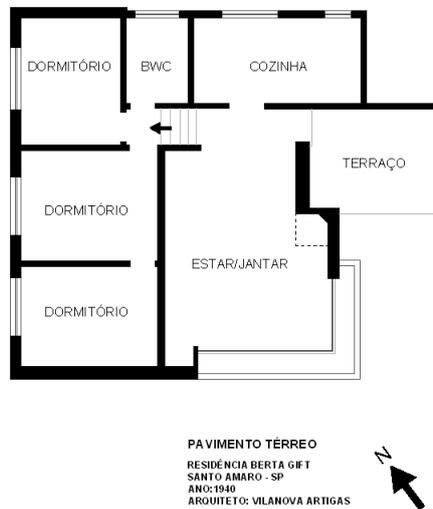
Redesenho da planta baixa da residência de Berta Gift.
